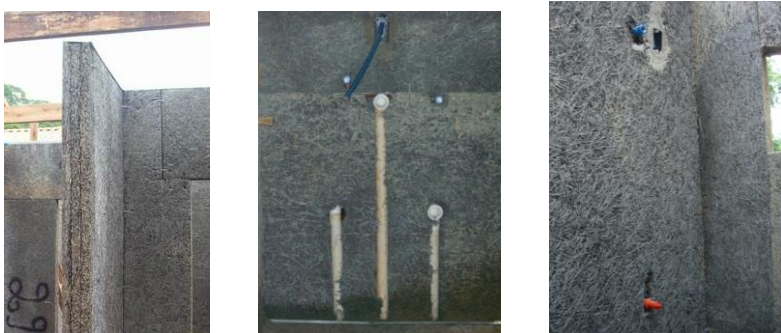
a) Tubulação hidráulica da cozinha, b) parede com três placas e c) tubulação hidráulica do banheiro. Fonte: Construpex (2009)
